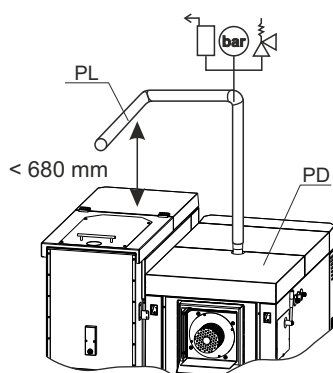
Příklady špatný konstrukce hlavní tok
